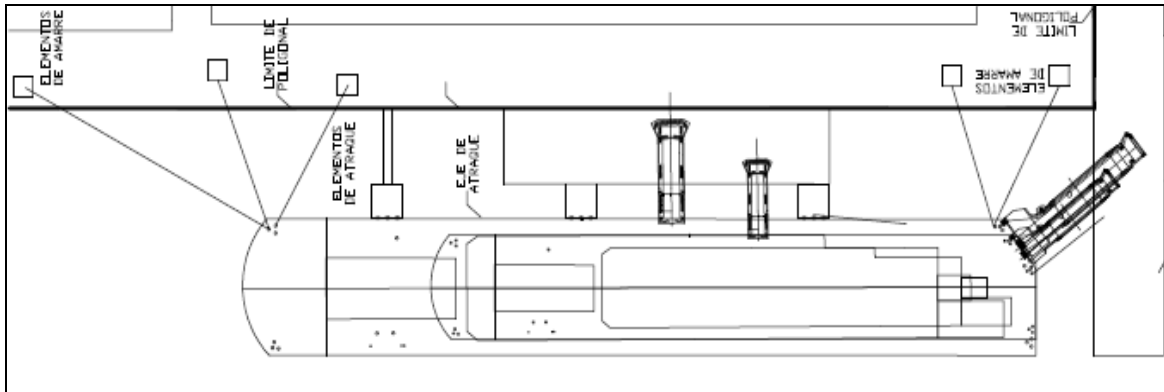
Planta del muelle propuesto para la terminal. Elaboración propia
